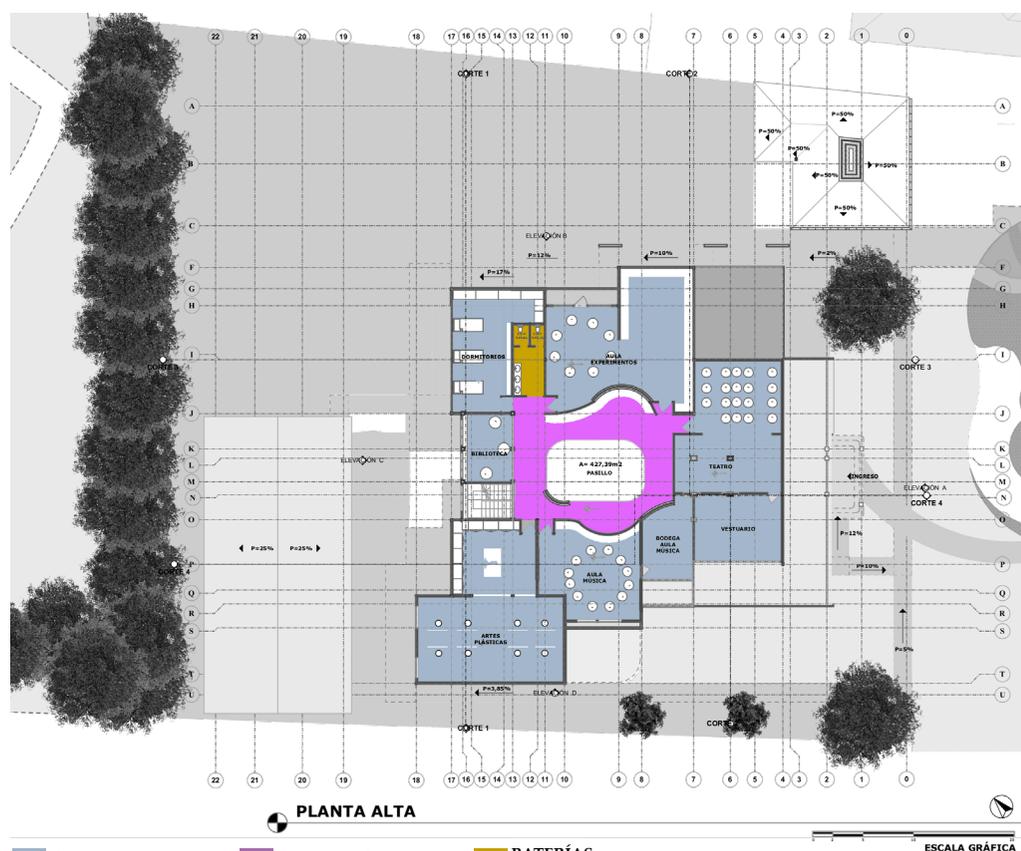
Planta Alta, planta de zonas. Fuente: Autora.
